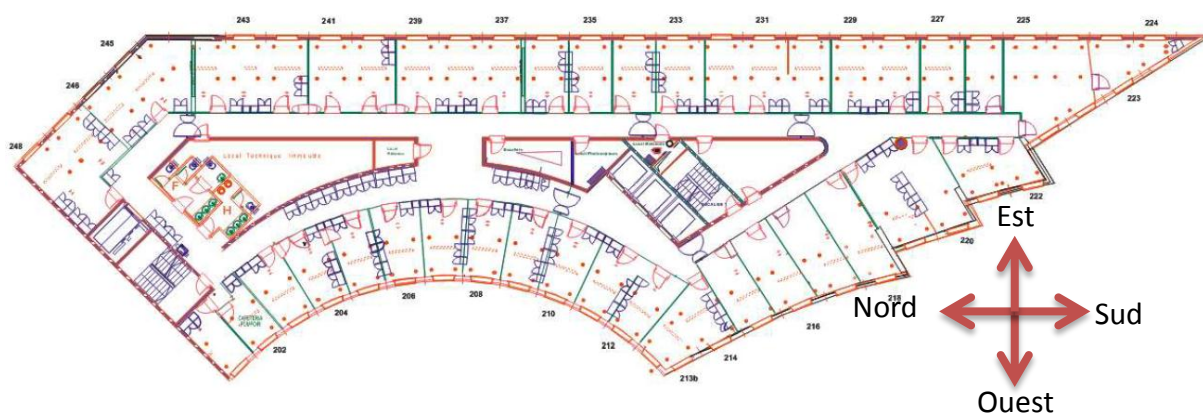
Plan de l'étage 2 du bâtiment modélisé
